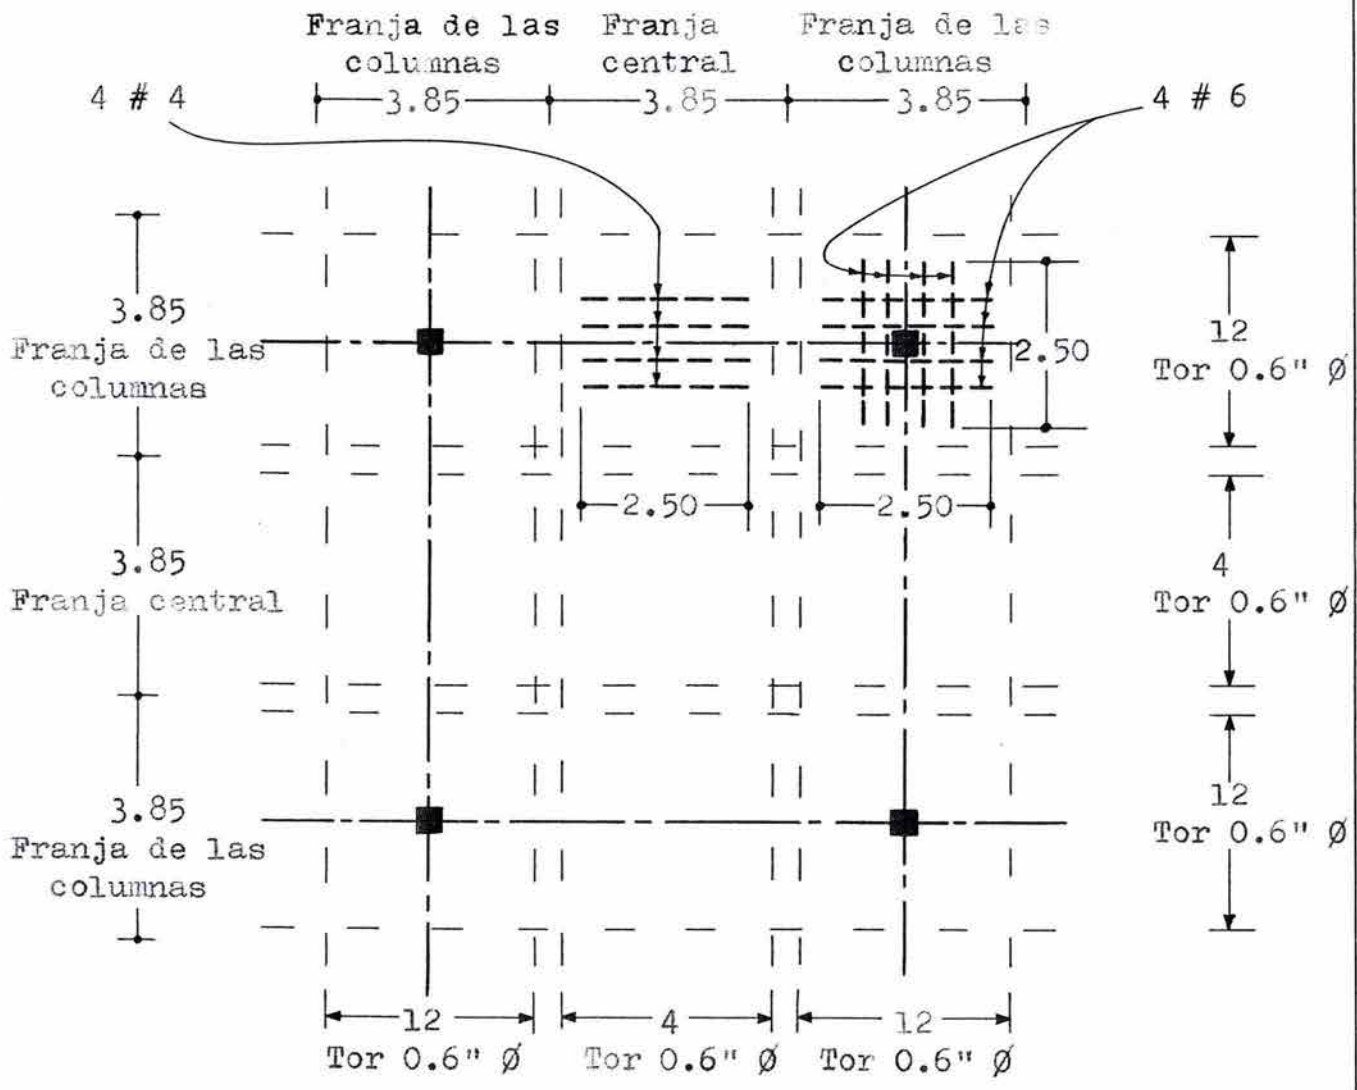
DISTRIBUCION DE LOS TENDONES DE PREESFUERZO Y DEL REFUERZO ADHERIDO EN UN PANEL INTERIOR DE LA LOSA PLANA.
